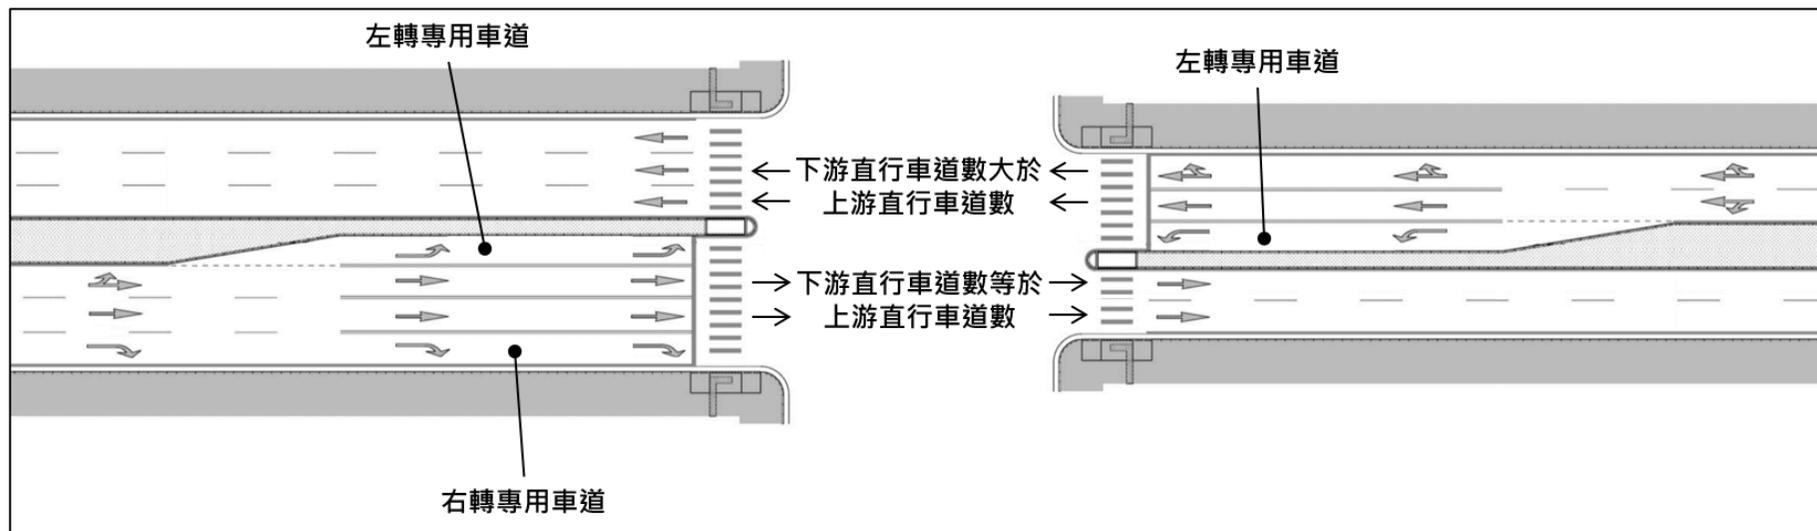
平面交叉路口上、下游車道數改變配置示意圖
